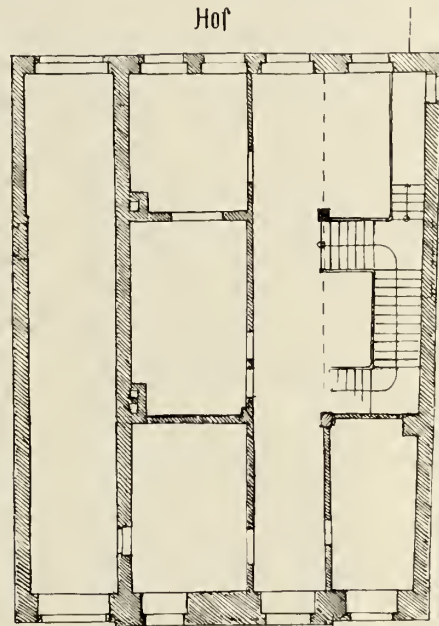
Hannover; Burgstraße 6, Grundriß.
